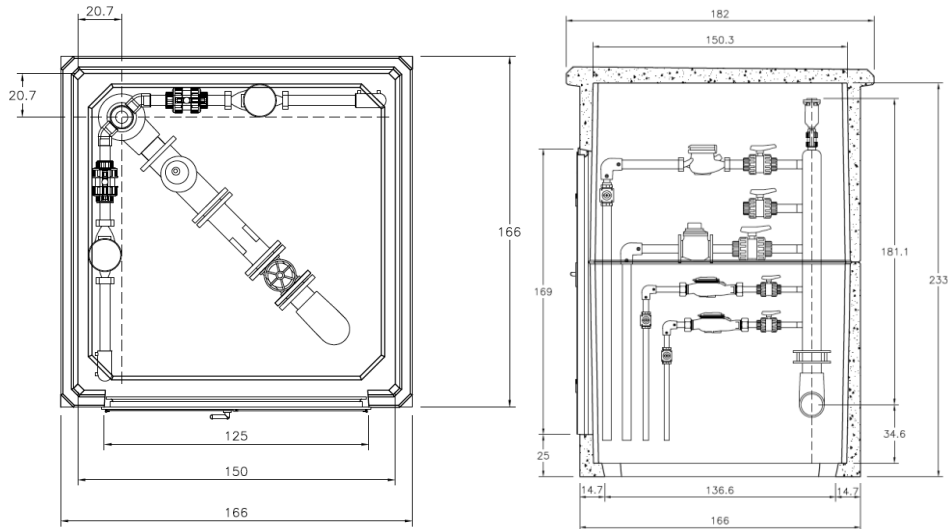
Secciones caseta recomendada hidrante tipo "Costella". Sección planta y lateral.
